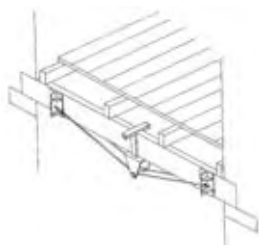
aplicação de pré-esforço na reabilitação de pavimentos de madeira.
